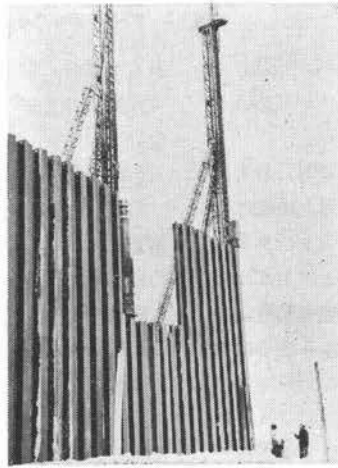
作業中の KH 46 型ディーゼルパイルハンマ
